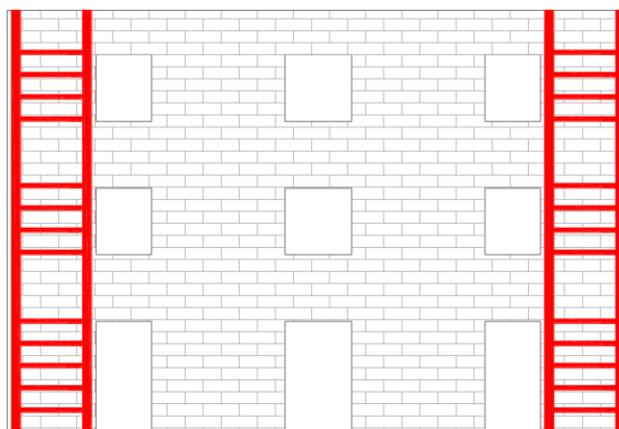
schema della disposizione del sistema di rinforzo FRP per la parete oggetto di studio.
